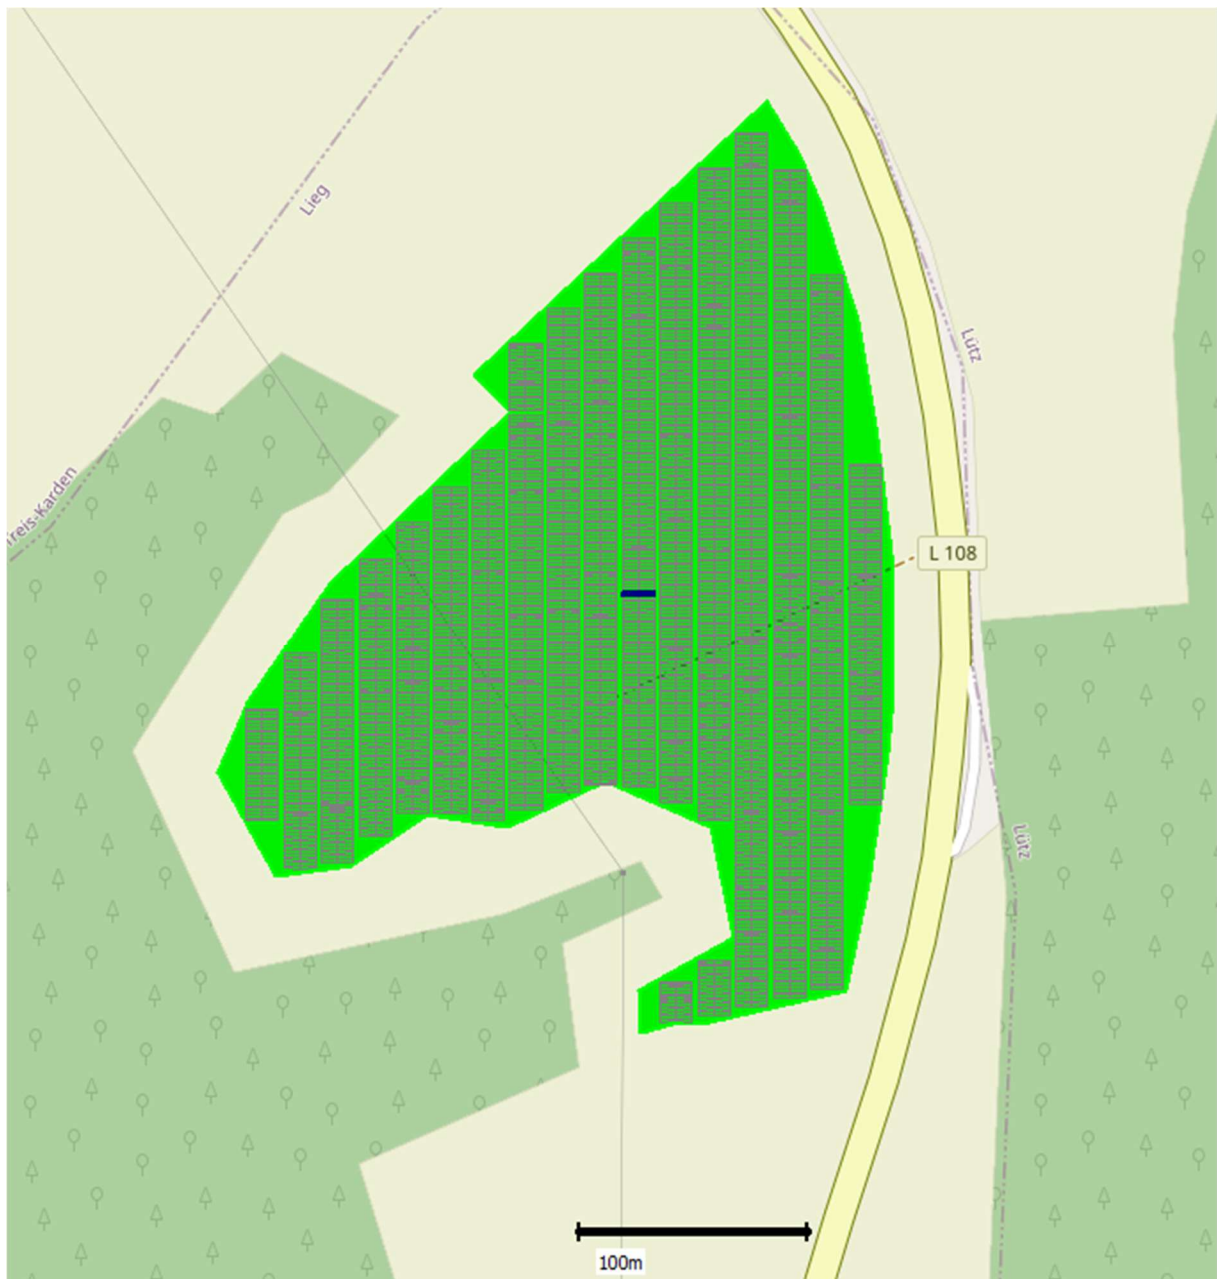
Lageplan - Teilfläche Nord mit PV-Anlage in einer Ost-West Ausrichtung mit 6er-Dach
